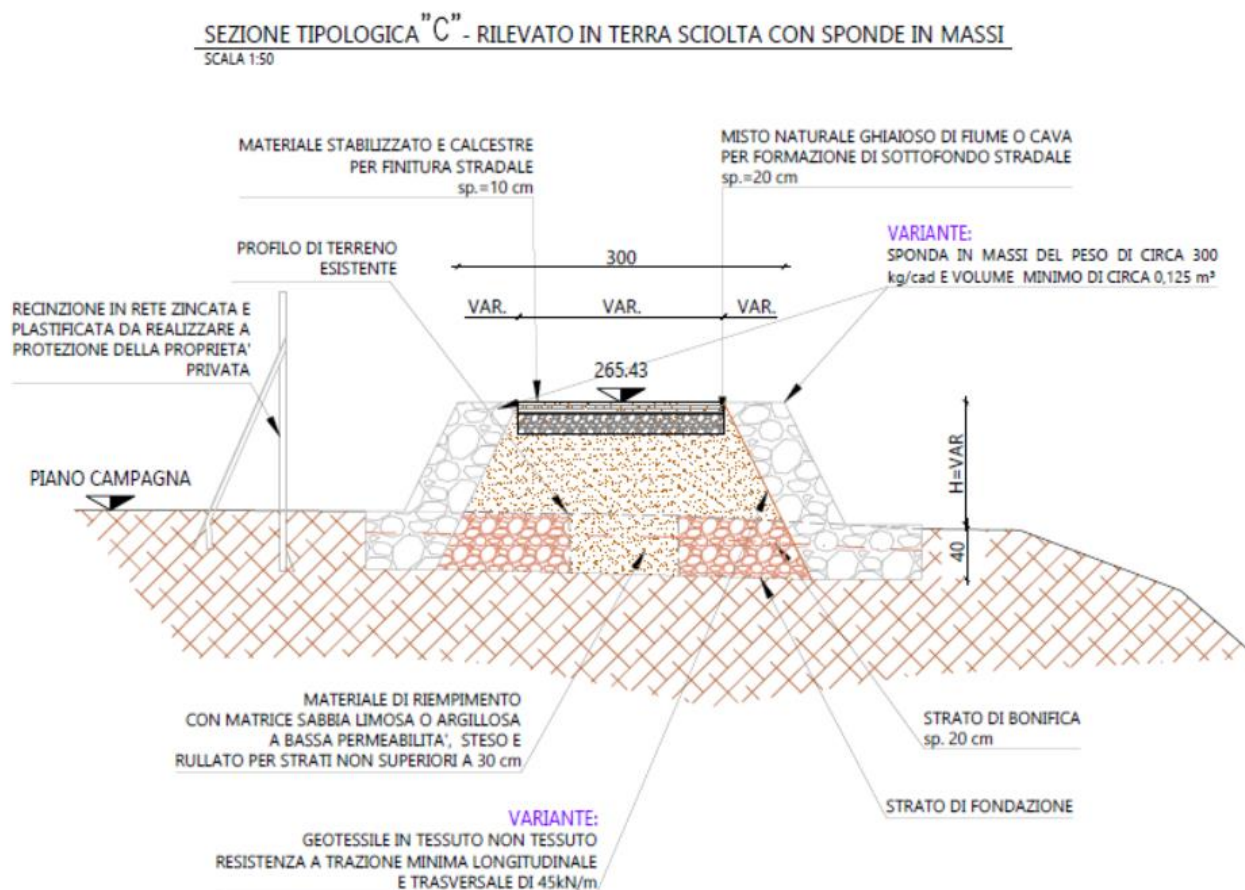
argine nord, soluzione in terra semplice con paramento in massi prevista dalla variante
